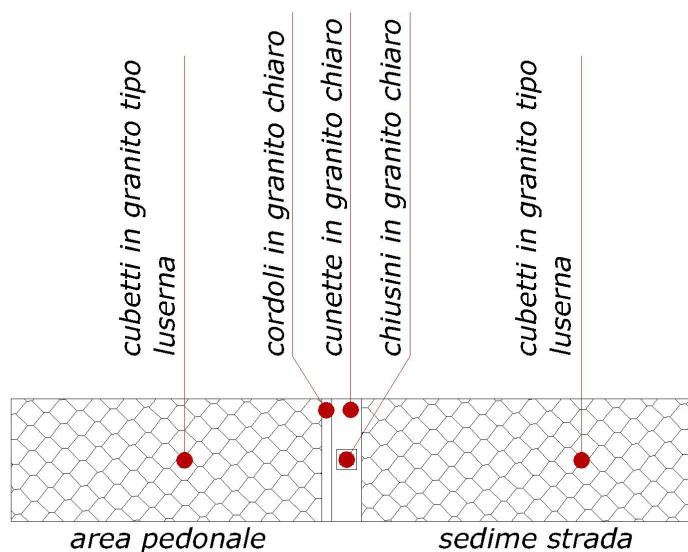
Schema delle nuove pavimentazioni della piazza - particolare vista orizzontale
